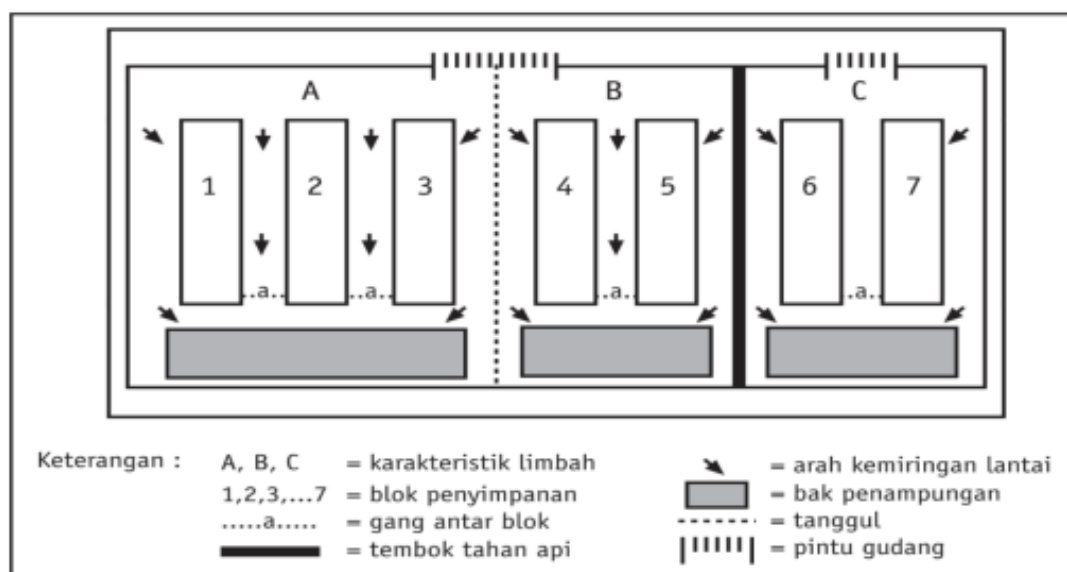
15 Contoh rancang bangun fasilitas Penyimpanan Limbah B3 dengan sirkulasi udara dalam ruang bangunan Penyimpanan Limbah B3
